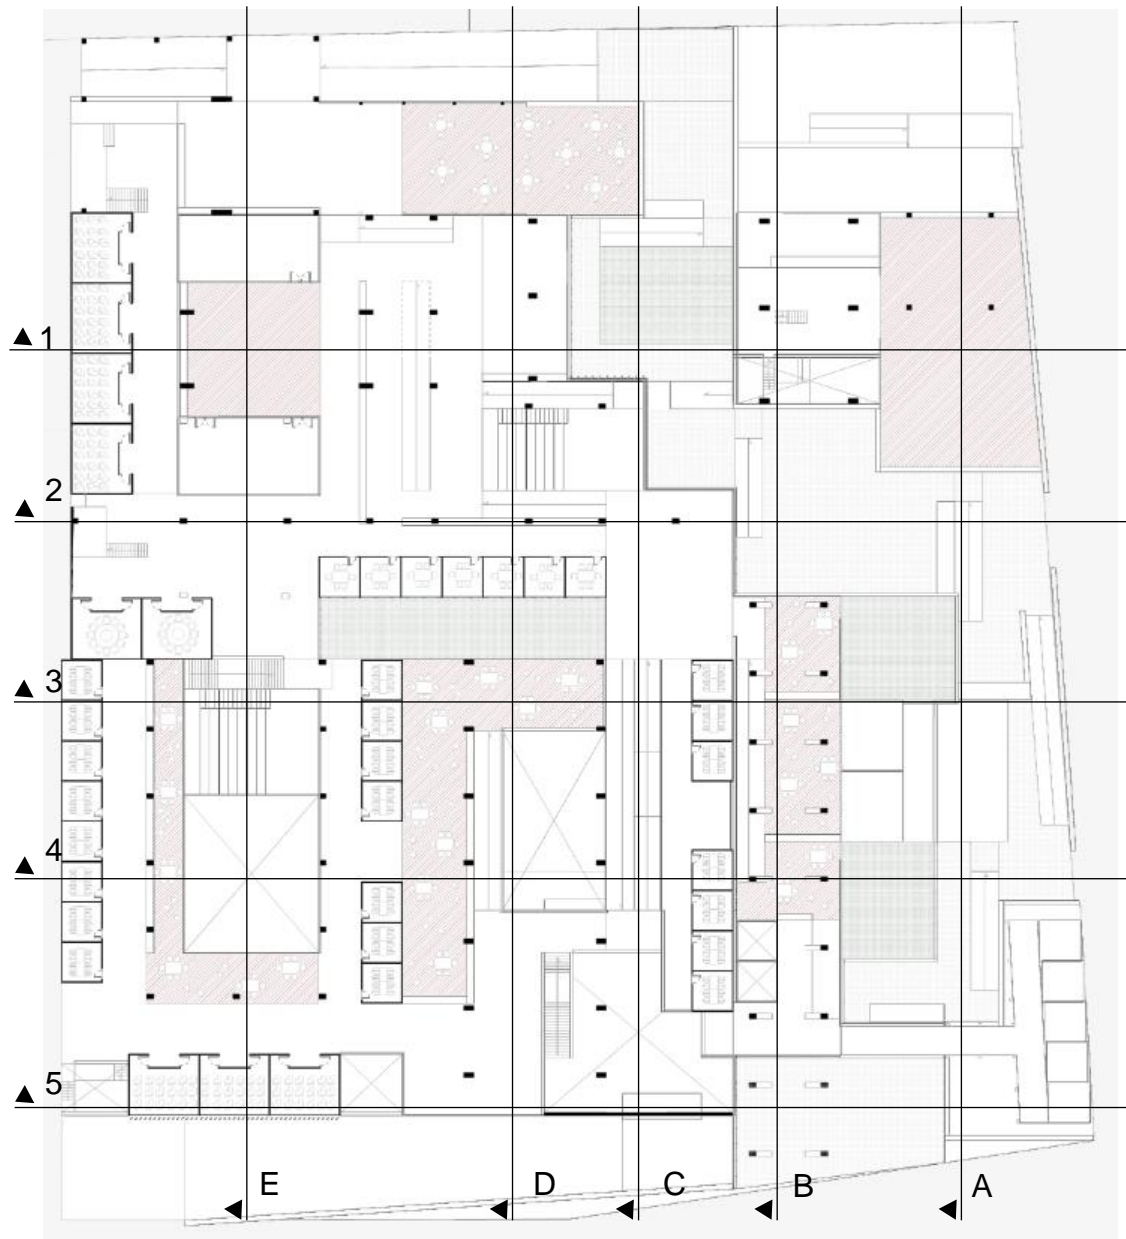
Planta arquitectónica. Segundo nivel, planta general
